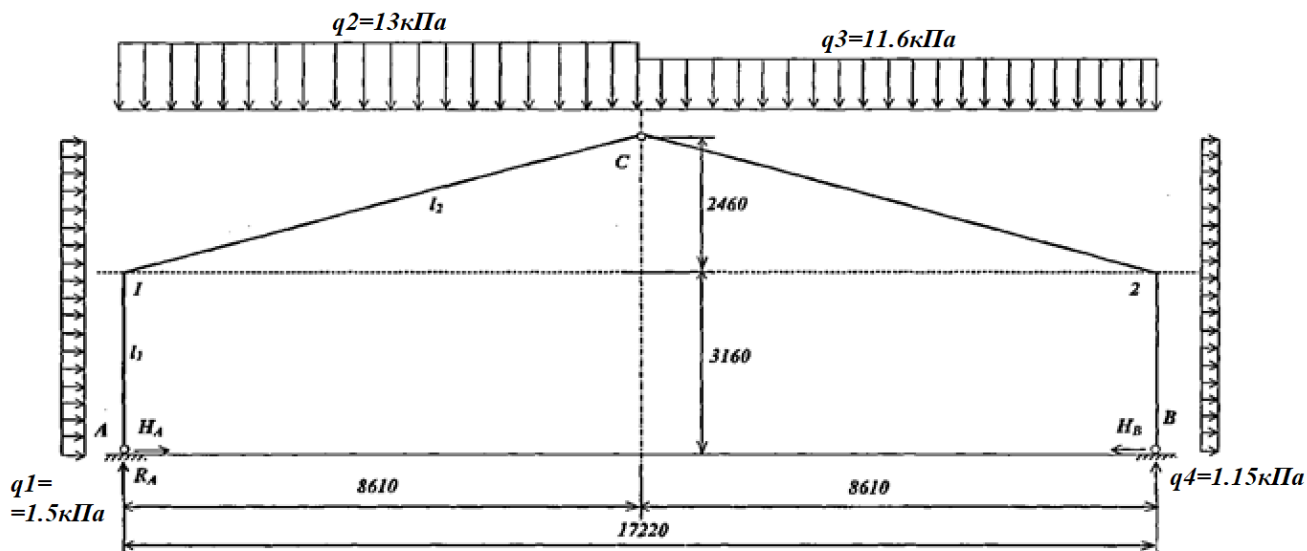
Розрахункова схема рами з вертикальною стіноювою конструкцією
